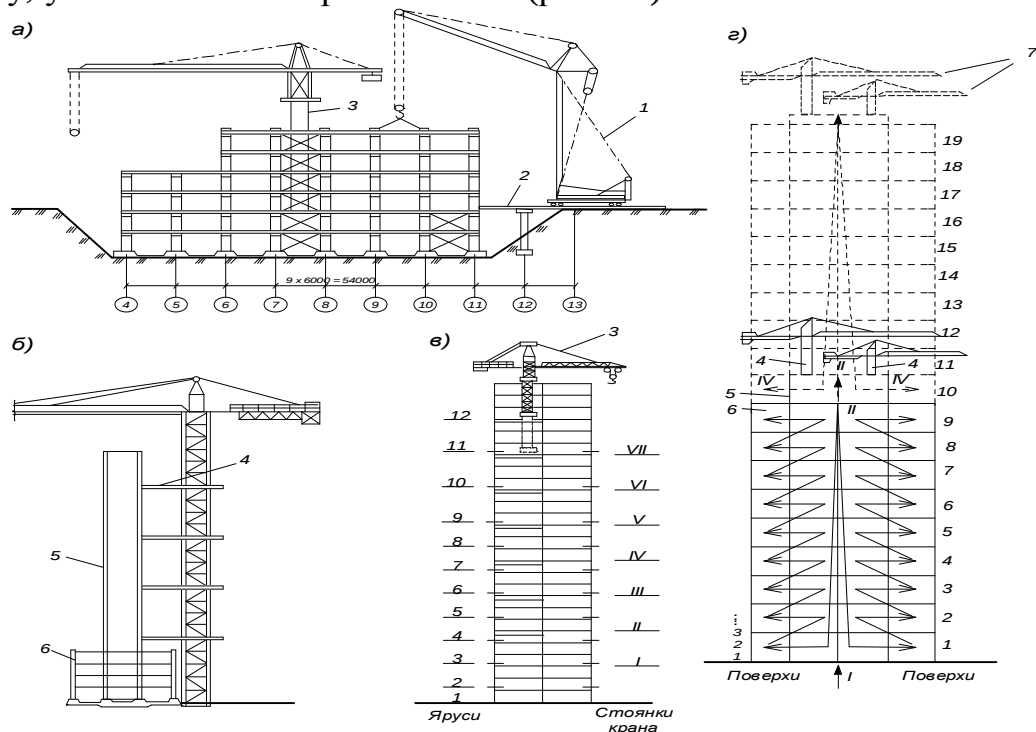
Схеми зведення висотних будинків: а – пересувним і самопідйомним краном; б – приставним краном; в – самопідйомним краном; г – двома самопідйомними кранами; 1,3,7– монтажні крани; 2 – шлях прямування крана; 4 – зв'язки; 5 – ядро жорсткості; 6 – сталевий каркас; I... VII – етапи робіт
